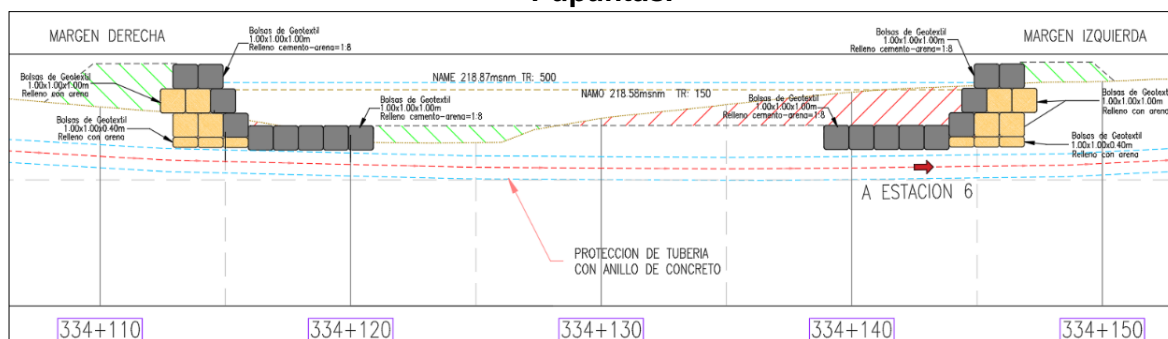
Detalle de relleno de zanja para tubería ONP.
